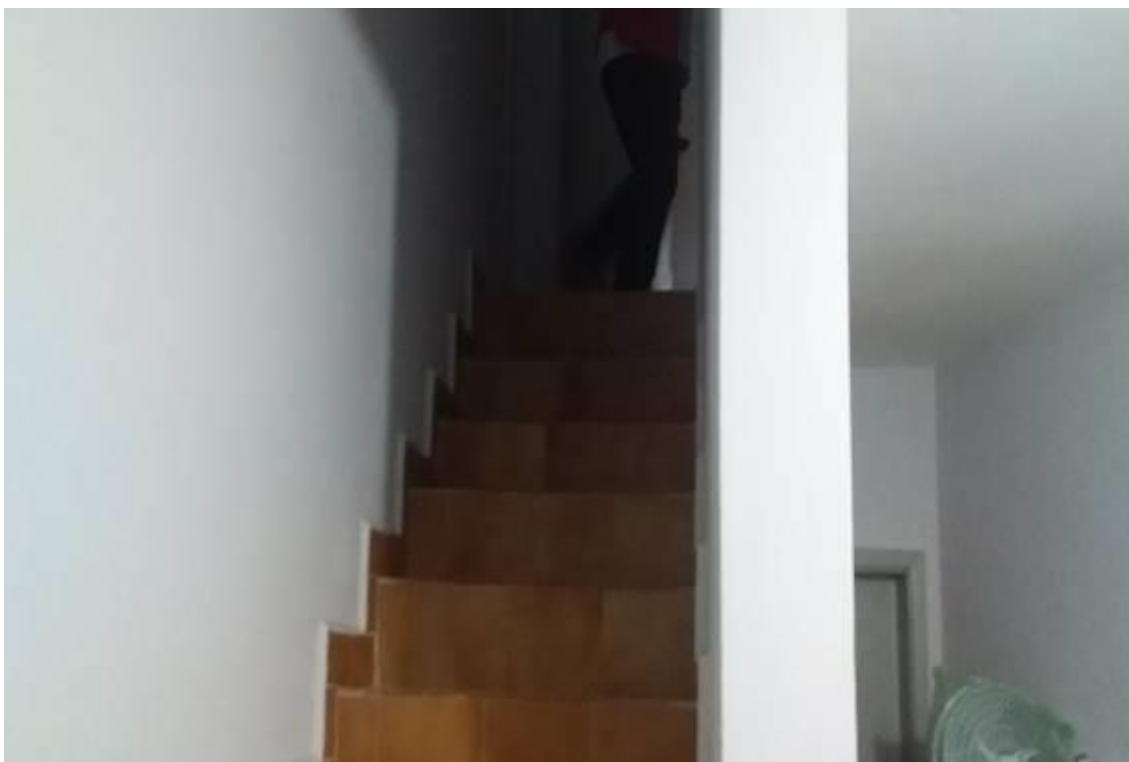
Vista da escada de acesso ao pavimento superior.
